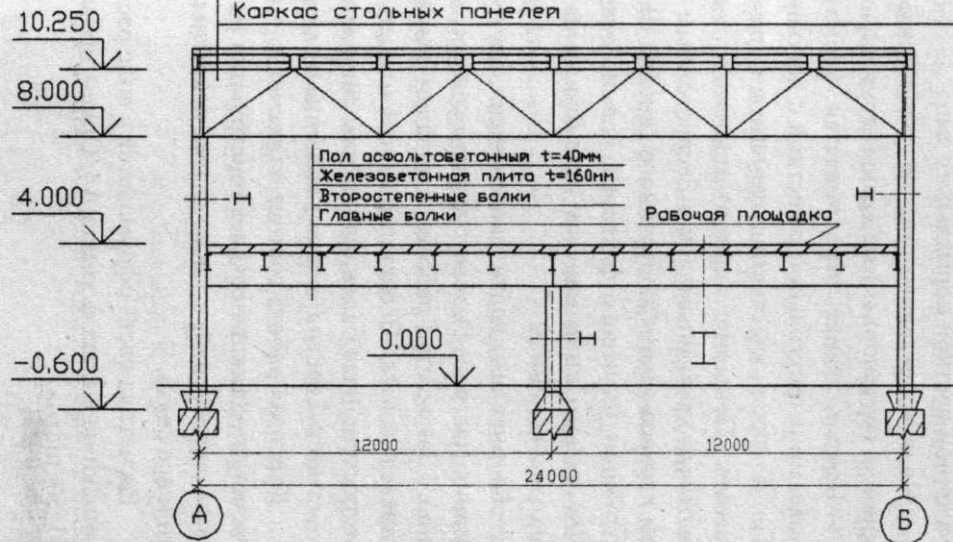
Поперечник здания пролетом 24 м. Пролет главных балок площадки 12 м
